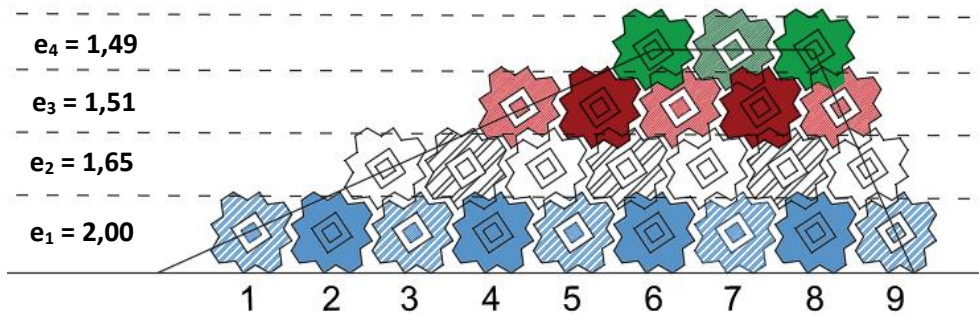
Espesor de las capas de la estructura diseñada. Fuente: Elaboración propia.
